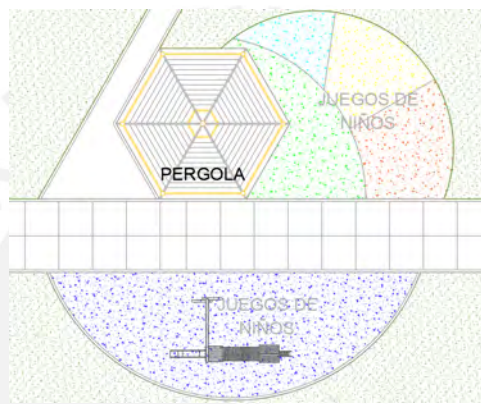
Planta de áreas comunes del proyecto Villanova Etapa 3.
